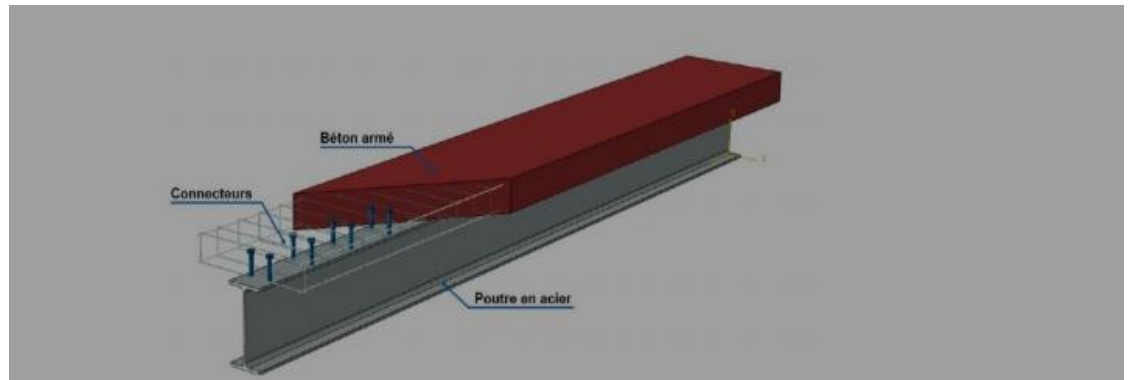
Poutre mixte acier-béton avec connecteurs soudés.[63]
